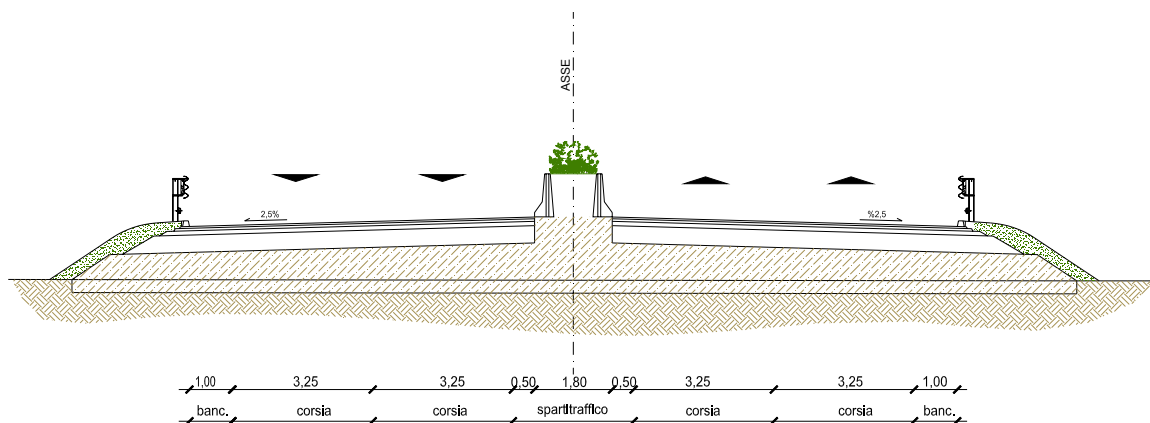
Sezione tipo della piattaforma stradale di progetto
